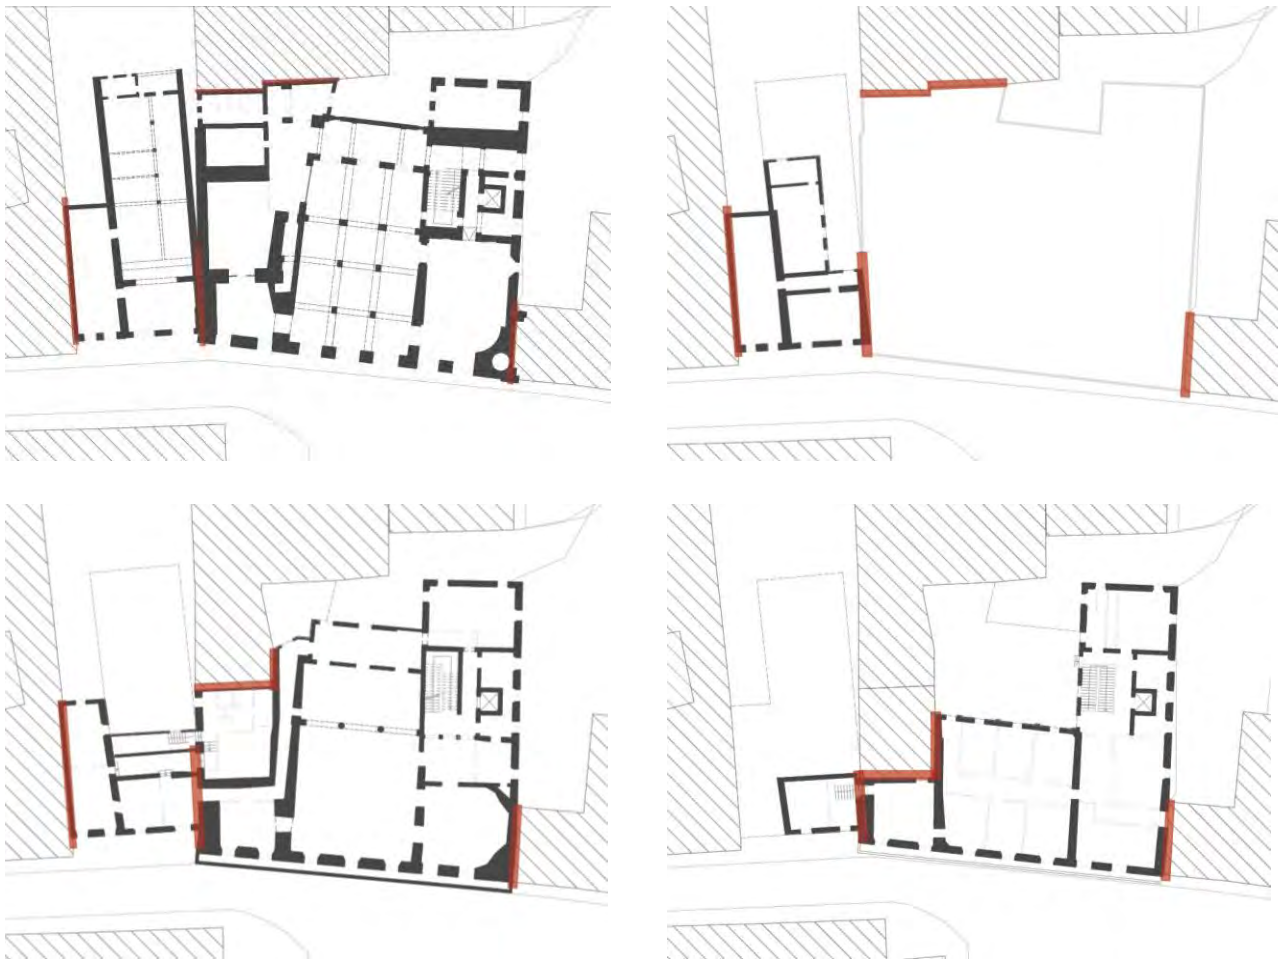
Setti vincolati del piano terra, piano ammezzato, piano secondo e piano terzo
